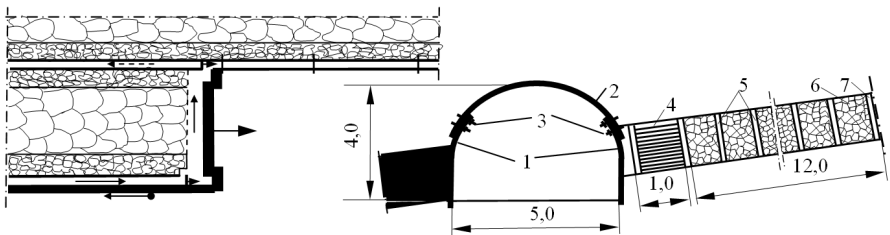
Охрана выработок бутовой полосой: 1 – ножки крепи; 2 – верхняк арочной крепи; 3 – замки крепи; 4 – чураковая стенка с укладкой стоек на глине; 5 – стойки деревянной крепи; 6 – бутовая полоса из породы от проведения конвейерного штрека; 7 – обрезающая органная крепь
